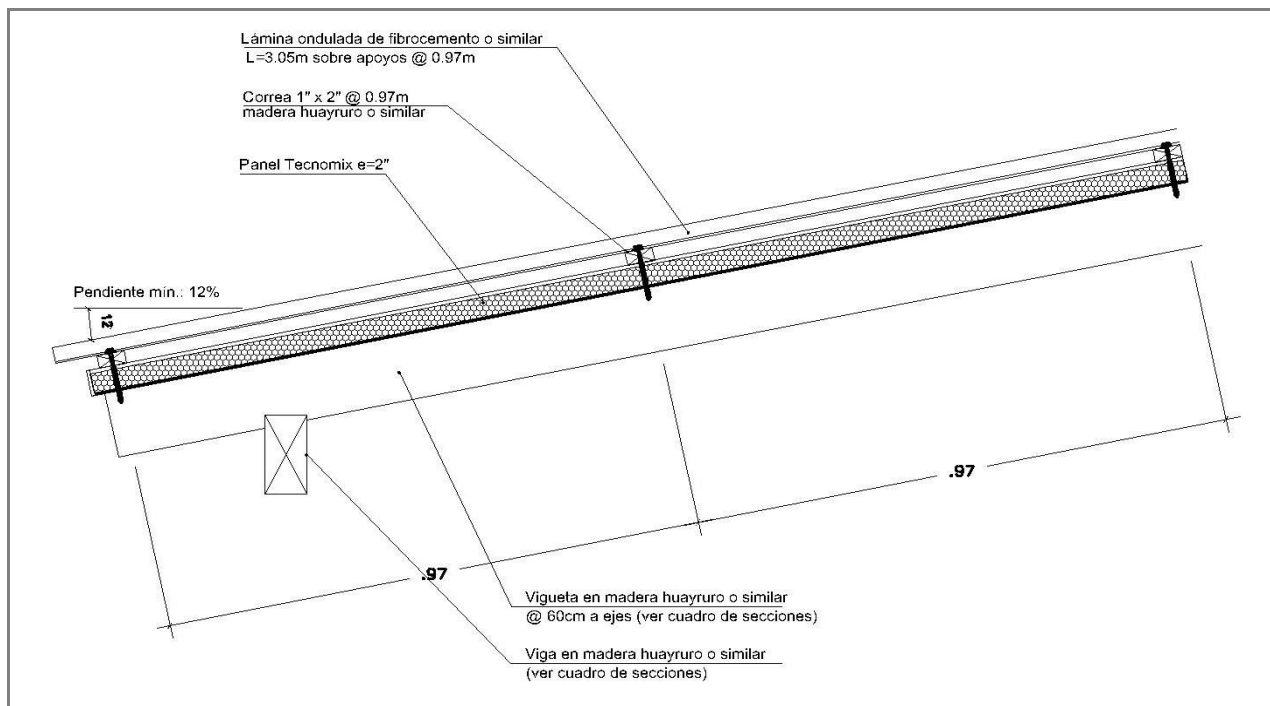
Corte de cobertura de panel TECNOMIX y lámina ondulada.
